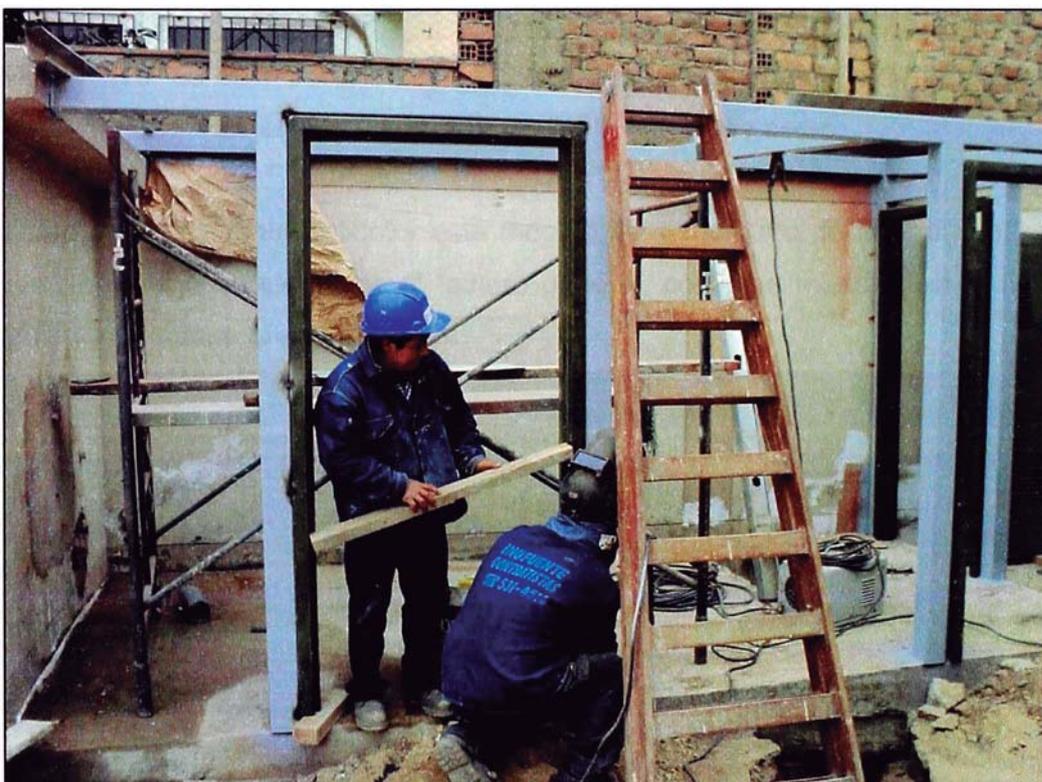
Se muestra la estructura del nuevo módulo, y también que las columnas se ubicaron estratégicamente también para soporte de los marcos de las puertas metálicas.
